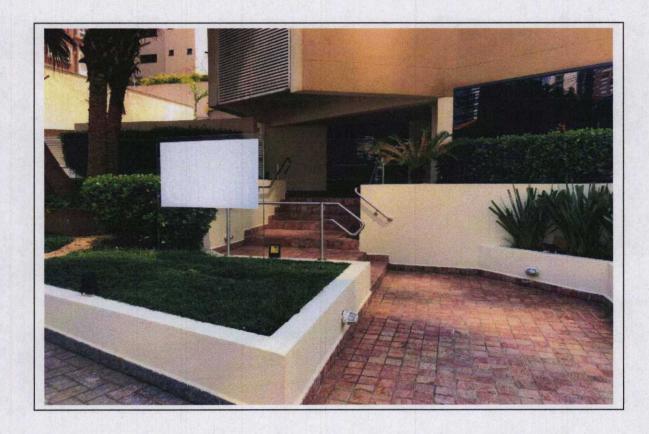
Vista do acesso para o interior do Edifício Palazzo Gritti onde se situa a sobreloja em estudo.
